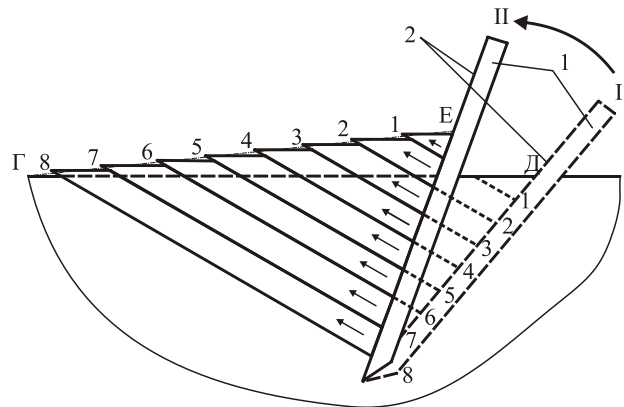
Схема разрушения грунта при работе анкерного устройства [10]:
